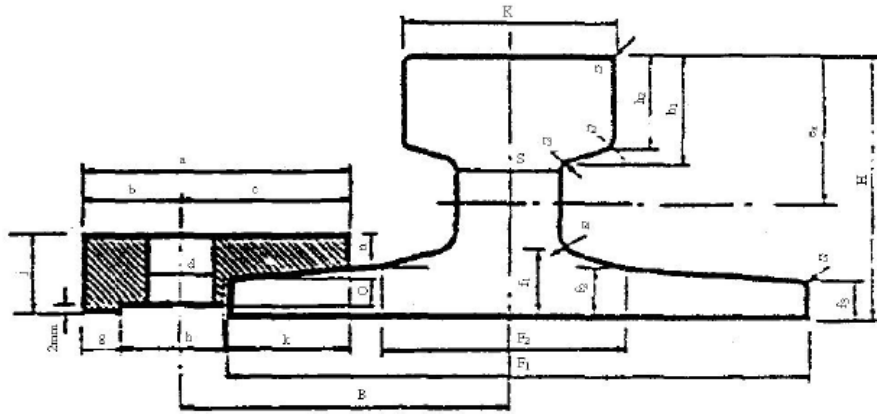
Dessin d'un rail et d'un crapaud.
